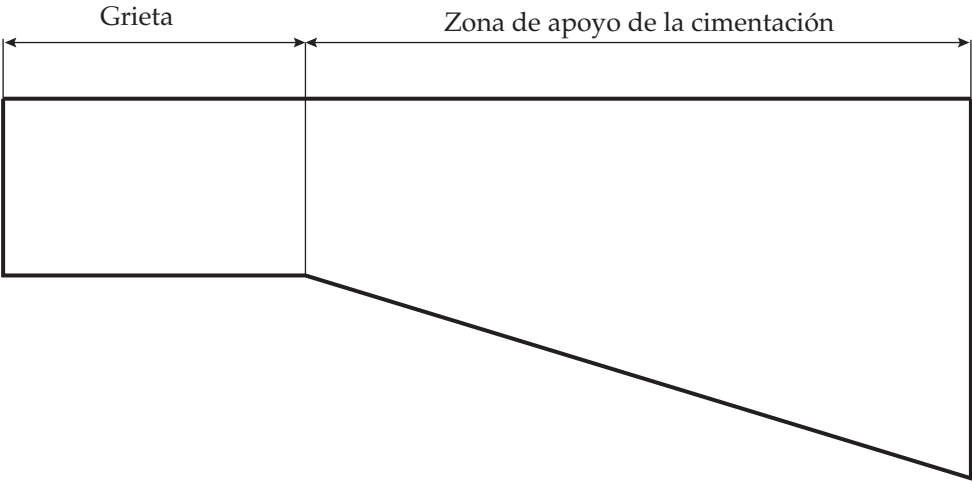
Grieta y zona de apoyo de la cimentación en una presa de gravedad.
